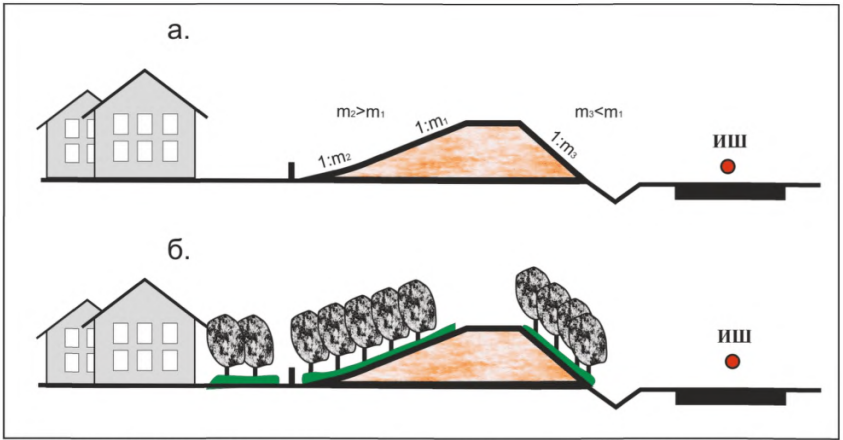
Схемы несимметричного шумозащитного вала (а) и его озеленение (б).
